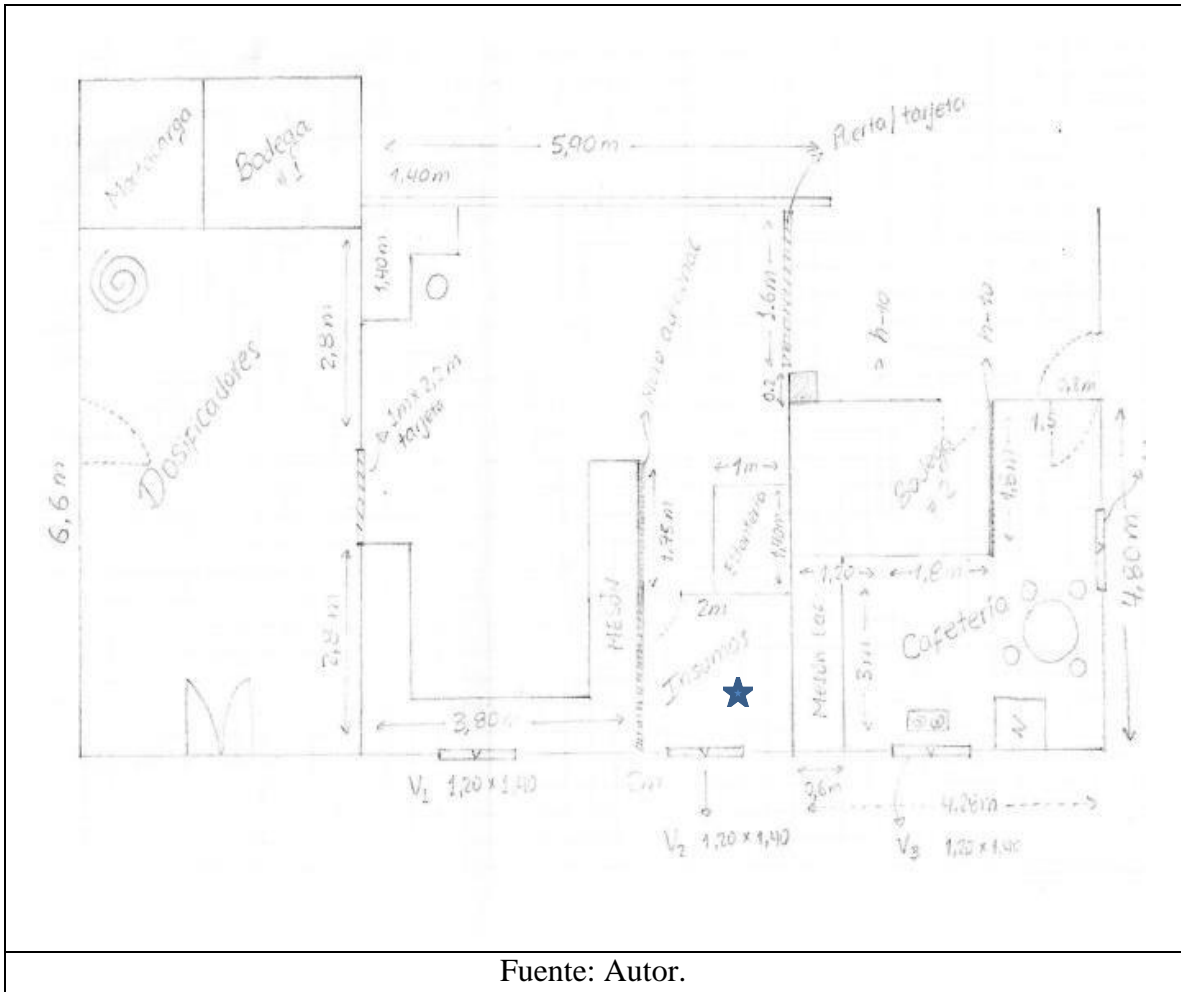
Proyecto remodelación primer piso Planta Morrorico
